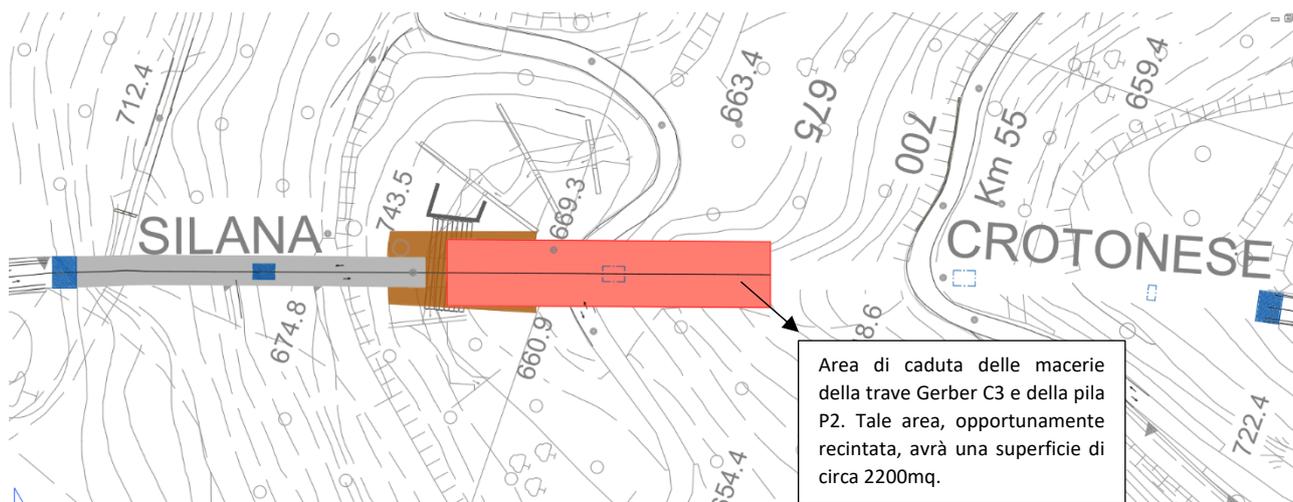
Estratto elaborato V382025002APA “Tavola della fasizzazione dell’intervento di demolizione (4 di 5)”
